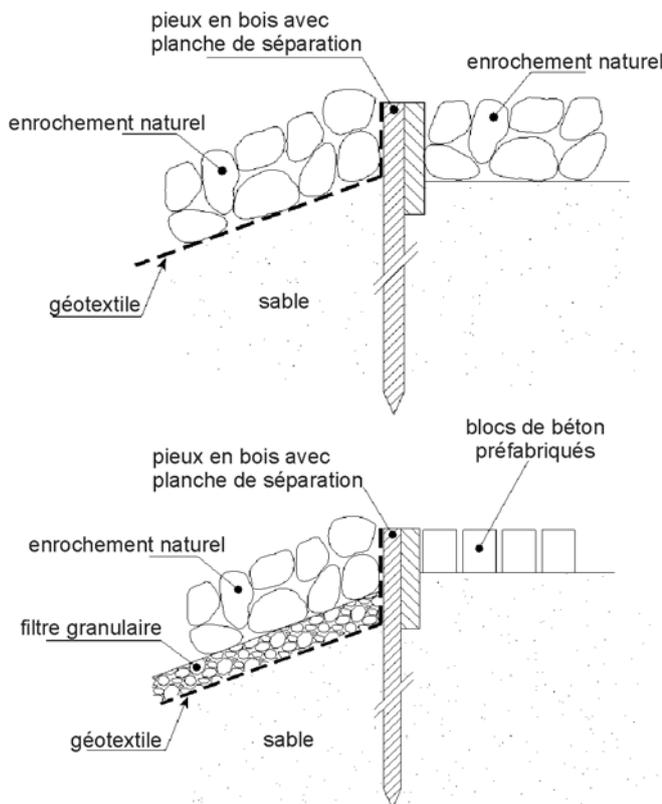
Exemple de berme d'un revêtement en enrochement
